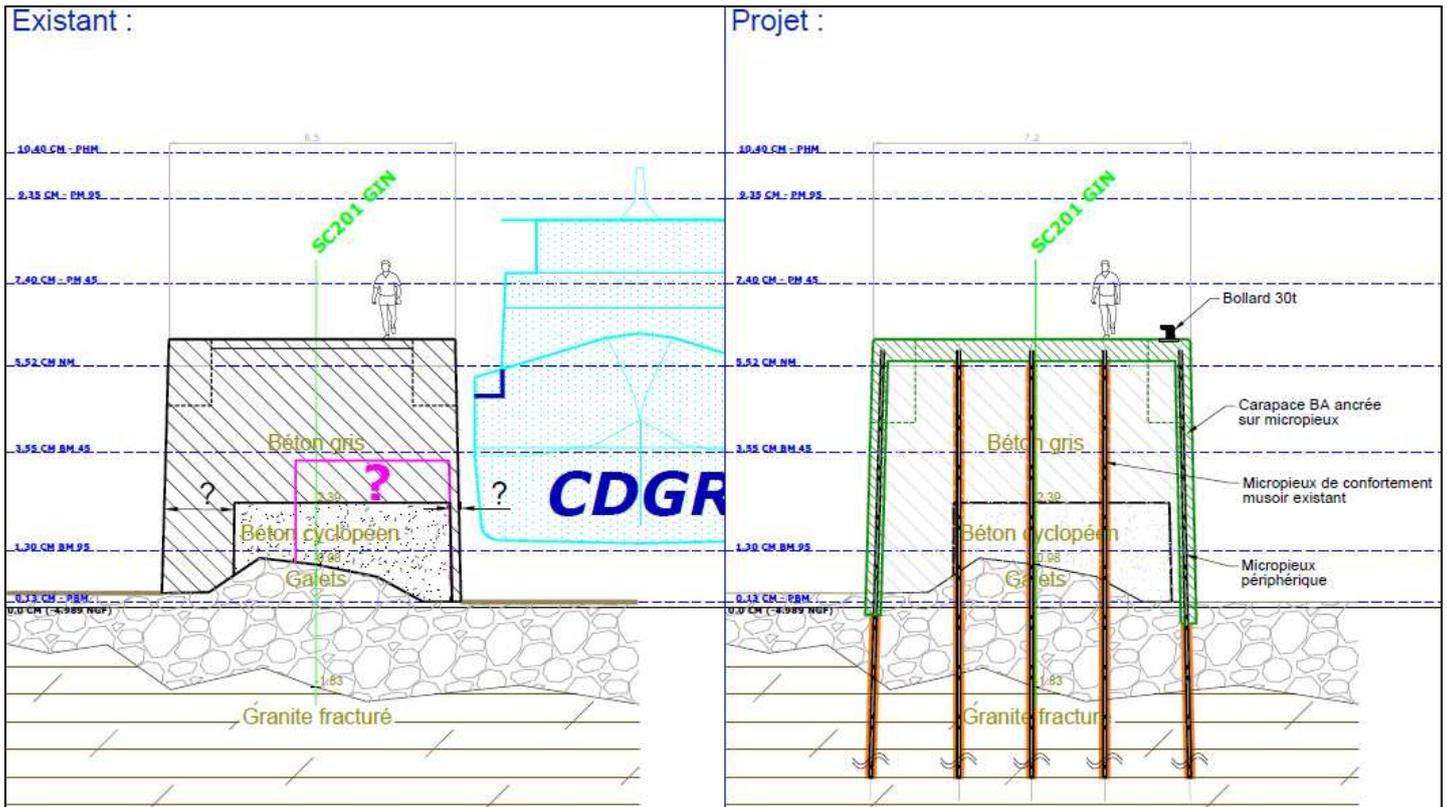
extrait coupe de principe solution retenue - Secteur A musoir.
